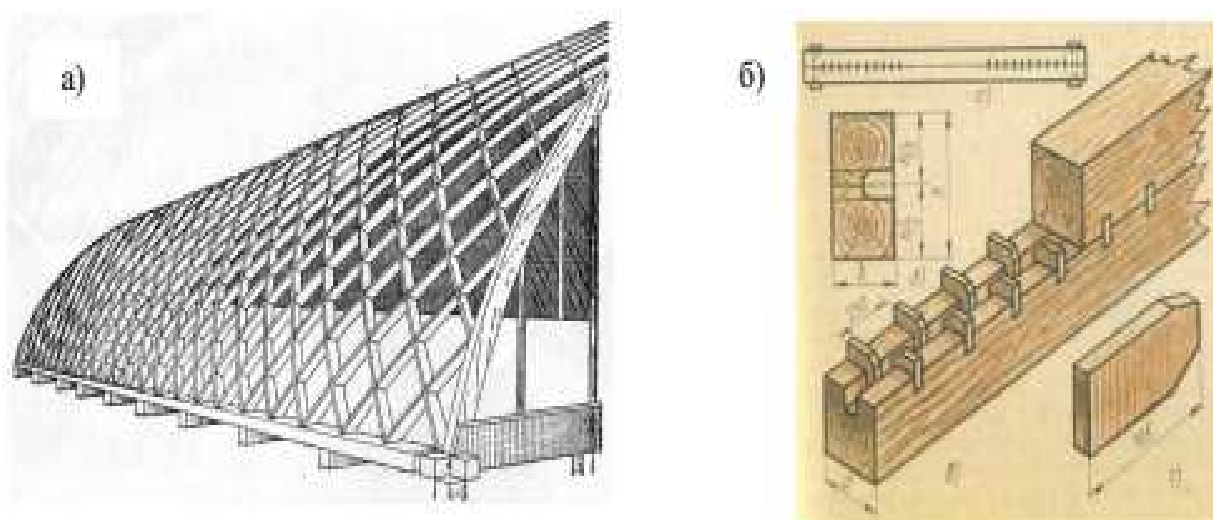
а – кружально-сетчатый свод С.И. Песельника, б – балка на пластинчатых нагелях В.С. Дервягина
